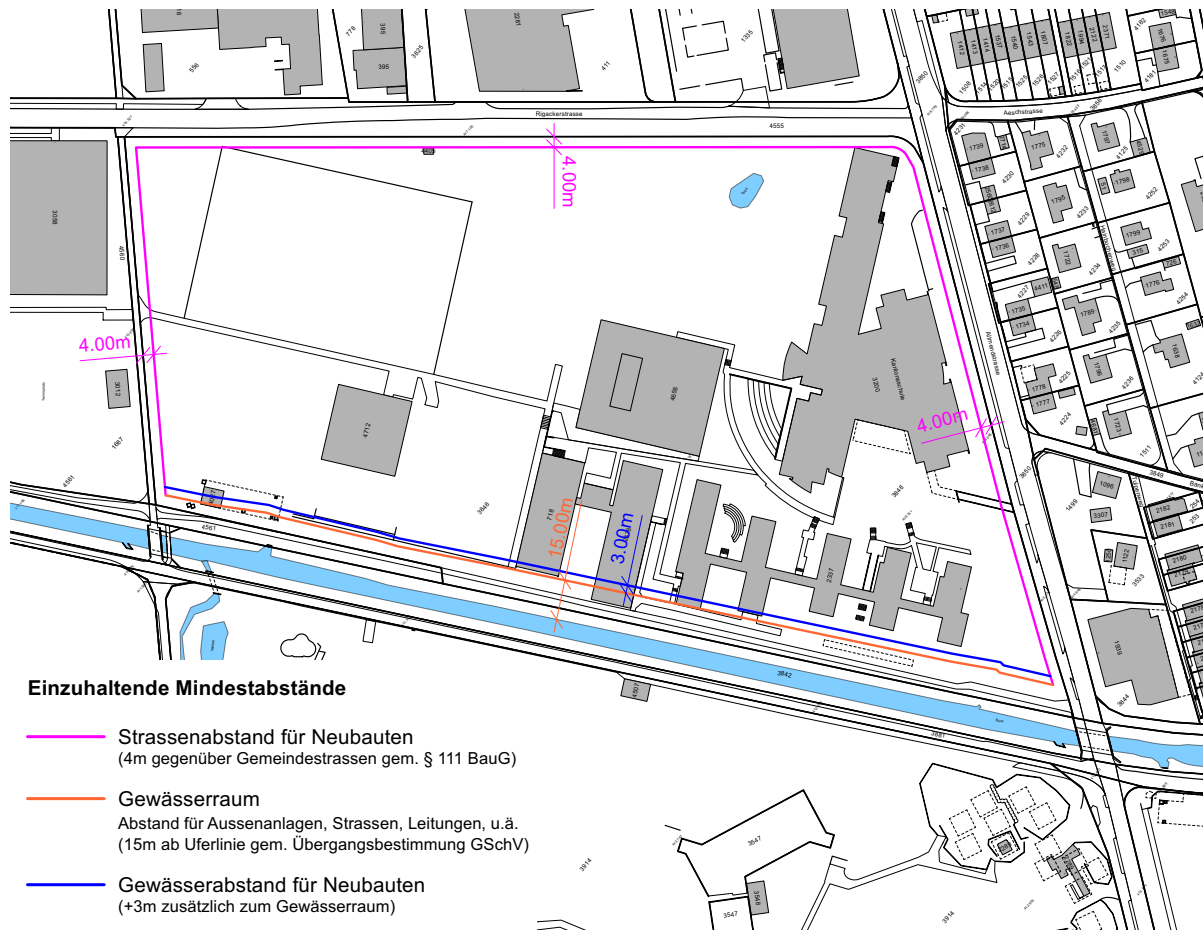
| Plan mit den baurechtlichen Mindestabständen [13]
